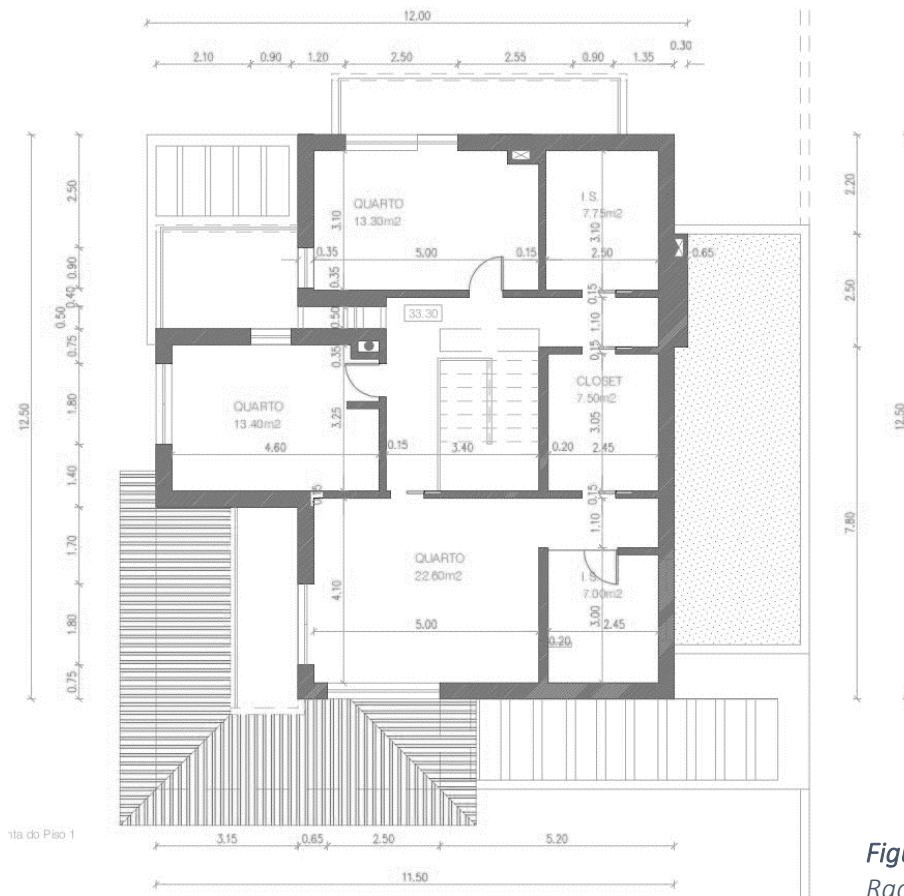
Planta Cotada, Piso 1 Raquel L.
